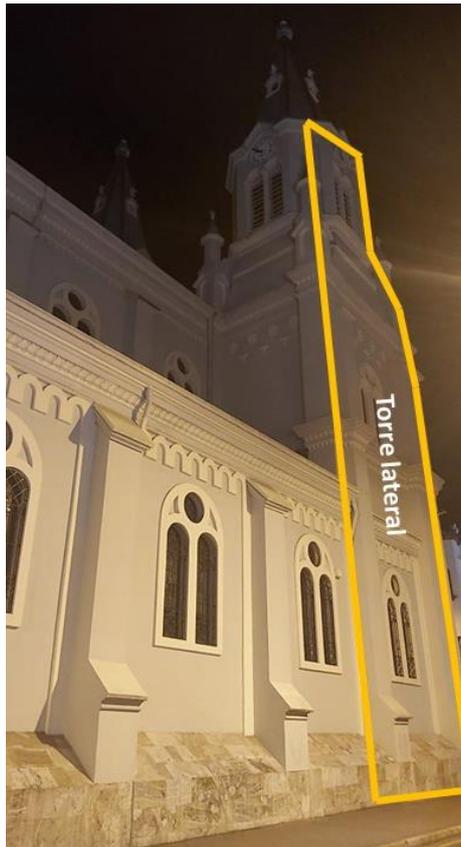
Sección fachada lateral torre iglesia San Alfonso. [Autores]
